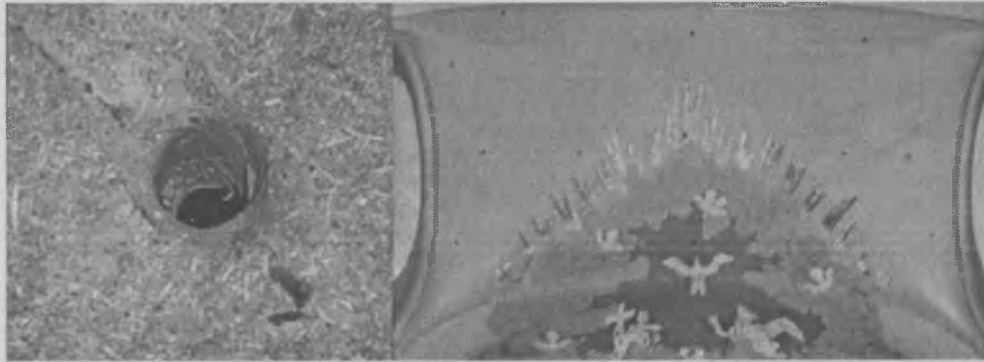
Отверстия в перекрытии чердака для удаления воздуха
